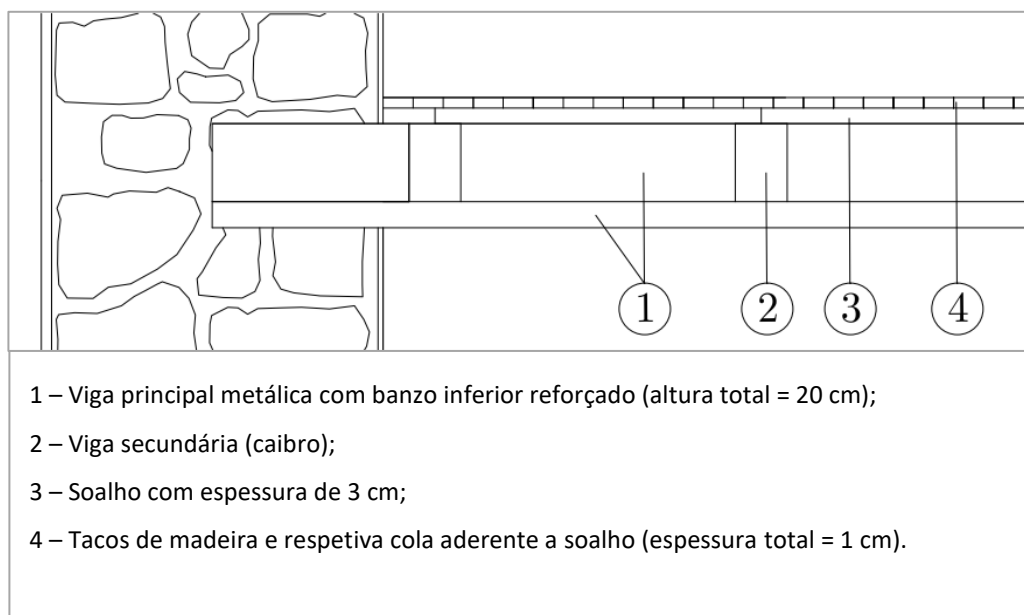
Estrutura do pavimento do edifício inicial.
